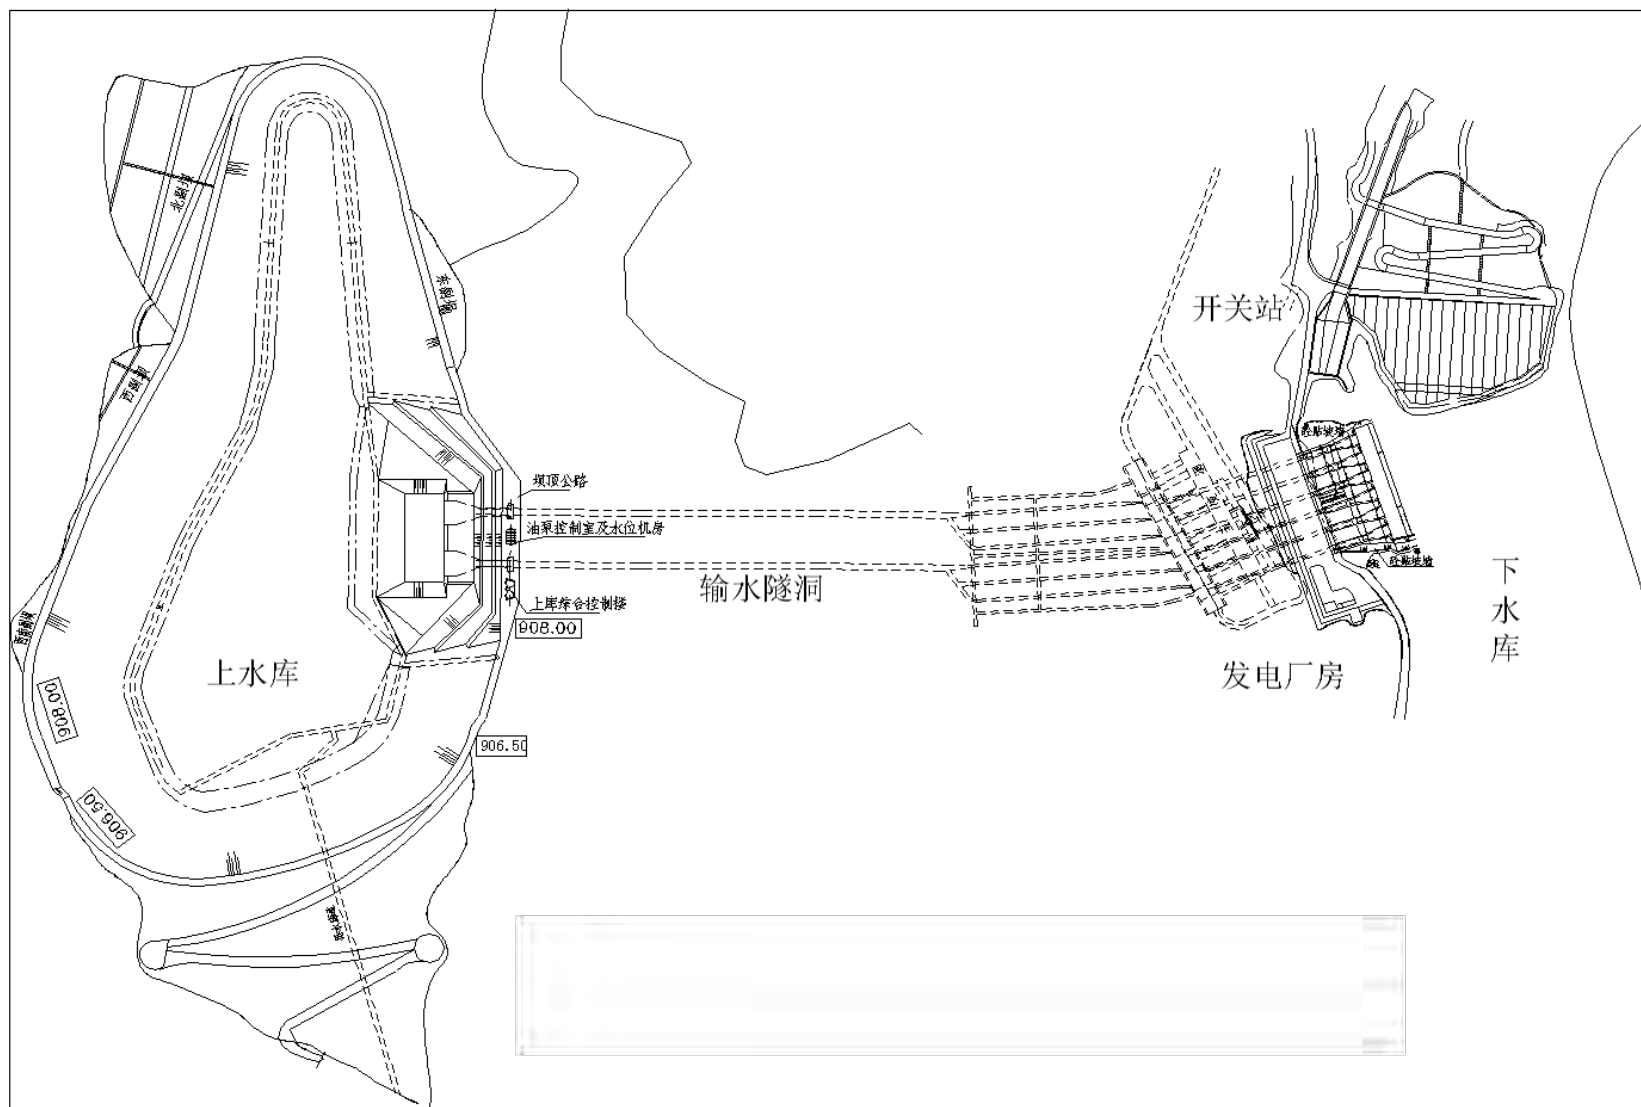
天荒坪抽水蓄能电站枢纽平面布置图
